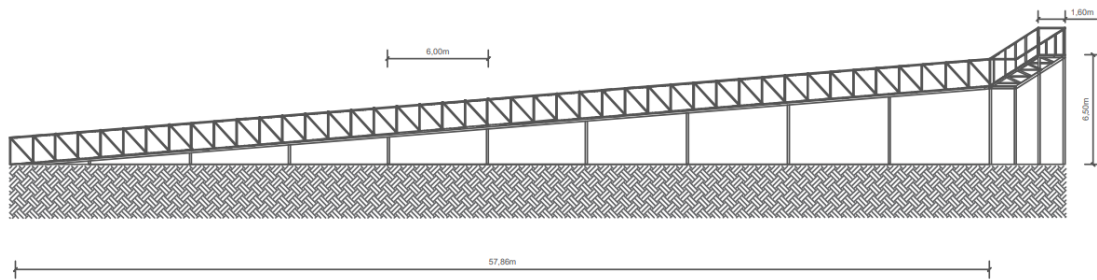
Detallado de Rampa Para Pasarela (AutoCAD)
